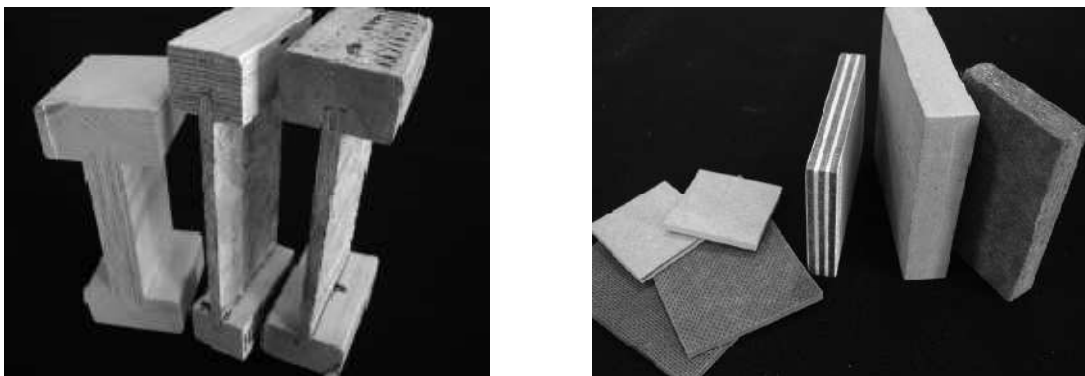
Vigas mixtas prefabricadas y tipos de tableros estructurales
